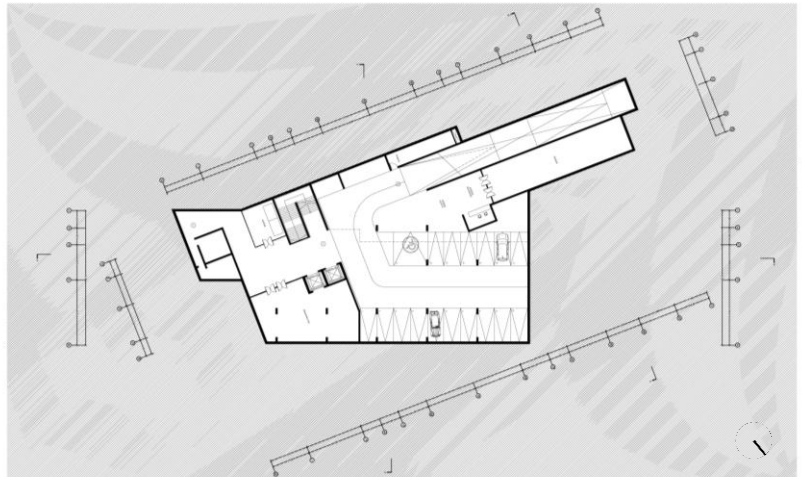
Planta estacionamientos y sala de máquinas (-3).
